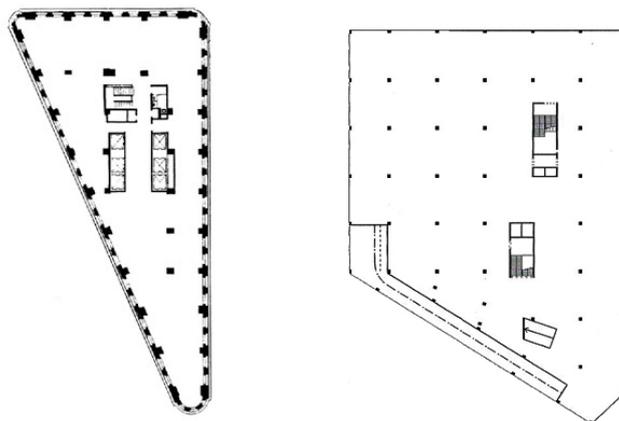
Planta típica de arranha-céu em NY e planta típica da Escola de Nantes. Editado a partir de KOOLHAAS, 1993 e RUBY, 2011.
